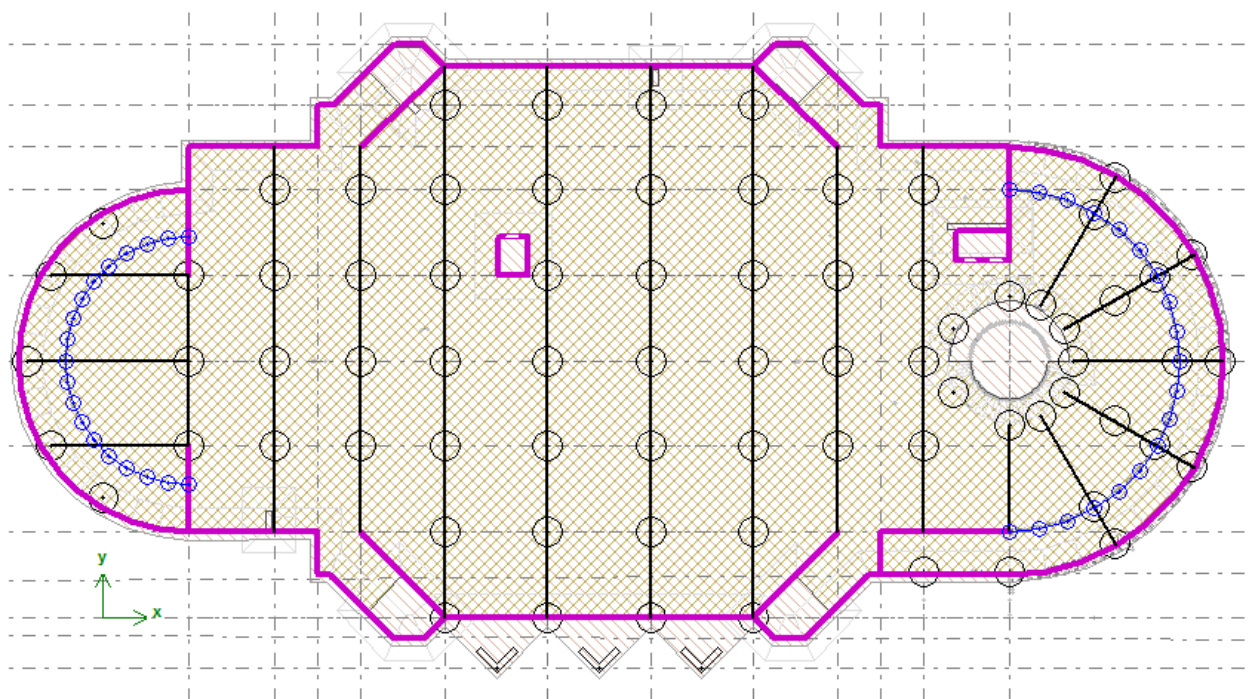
Розрахункова схема підвального поверху будівлі (на відм. -4,200)
